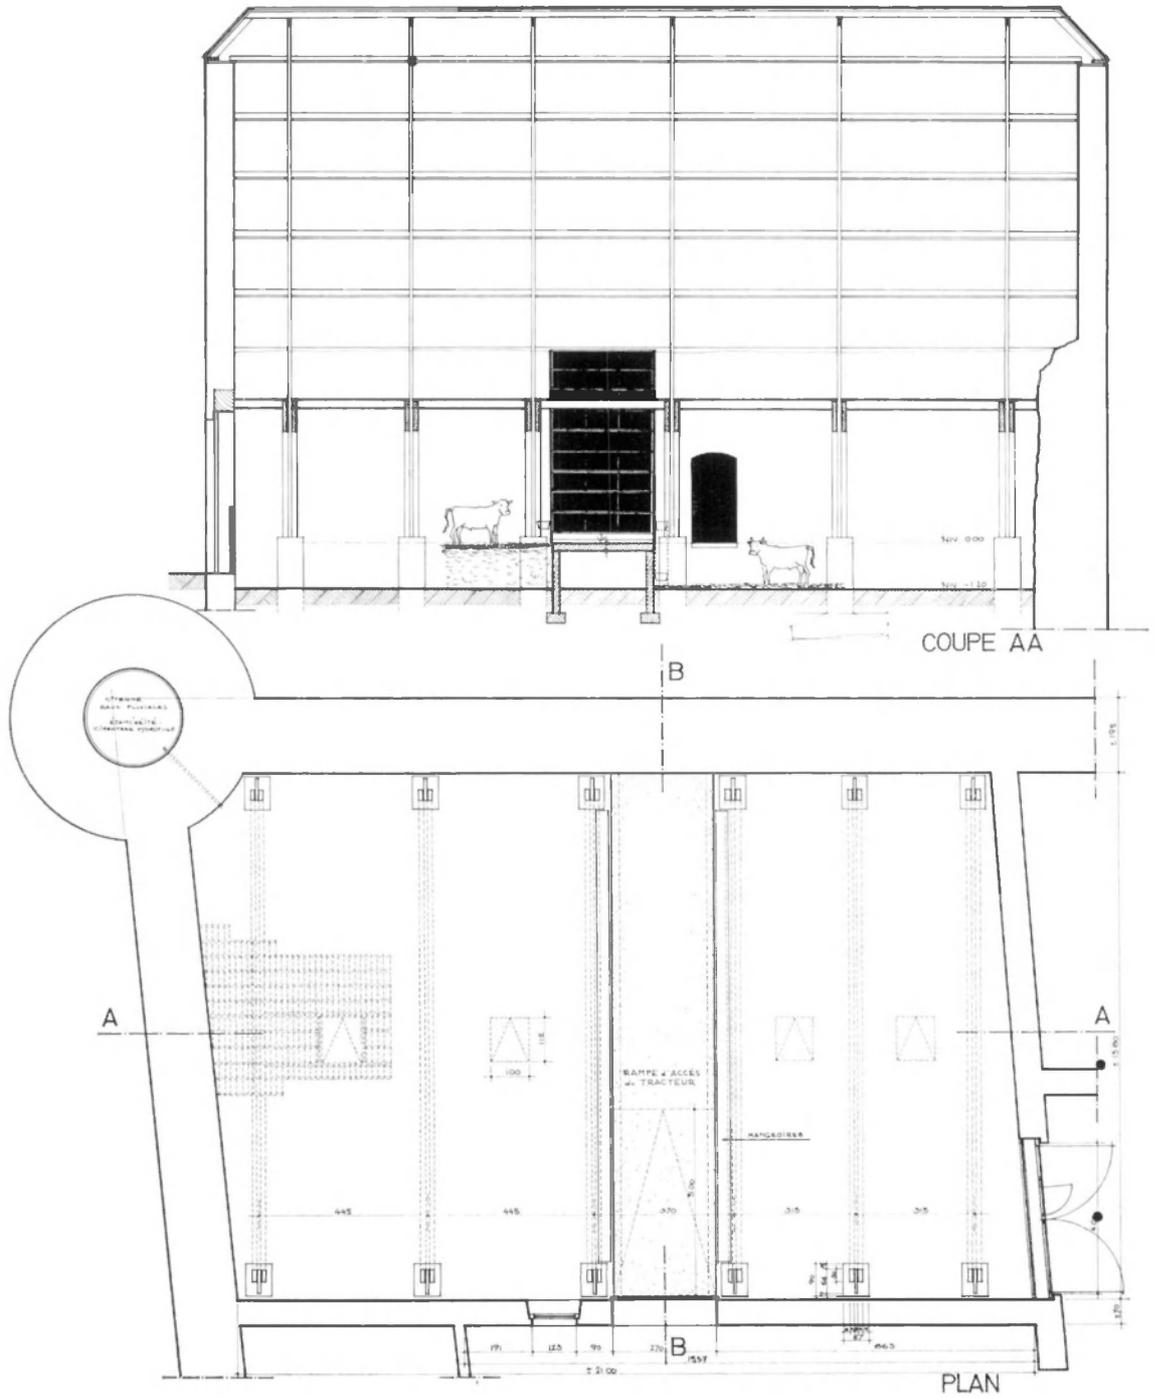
Opprebais. Plan et coupes de l'aménagement. Echelle 1:200. Sur la coupe AA, deux vaches situent les niveaux progressifs de montée du fumier. La porte sectionnable dessinée sur cette même coupe n'est qu'une variante possible.
